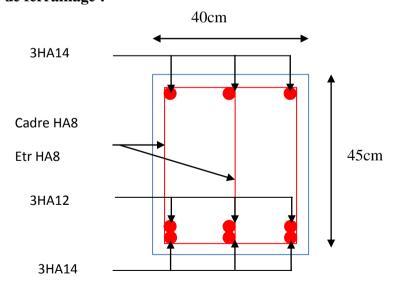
Schéma de ferraillage de la poutre brisée.
